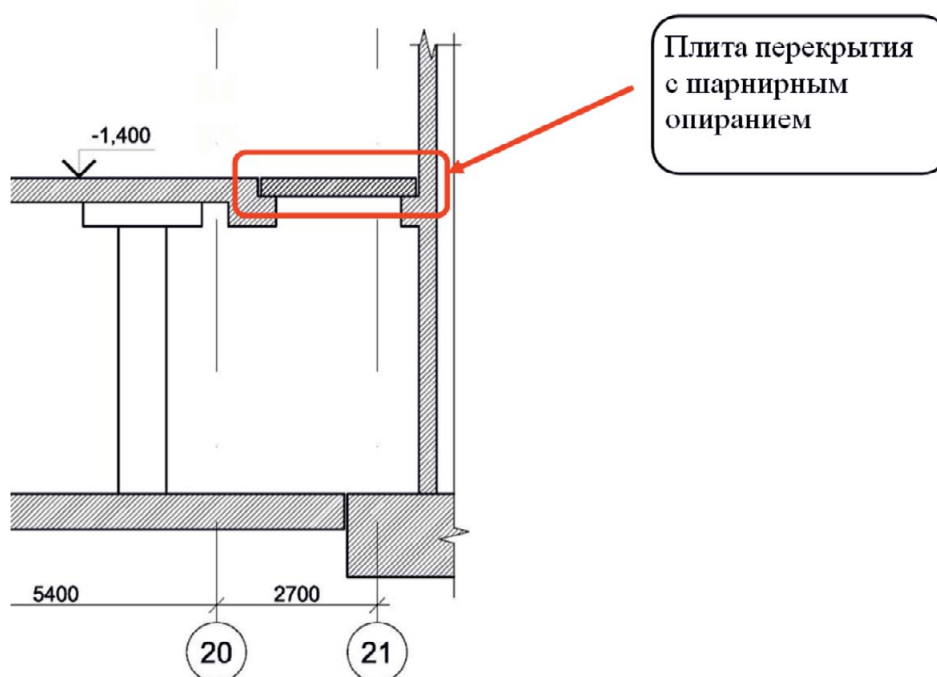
Пример плиты перекрытия с шарнирным опиранием
